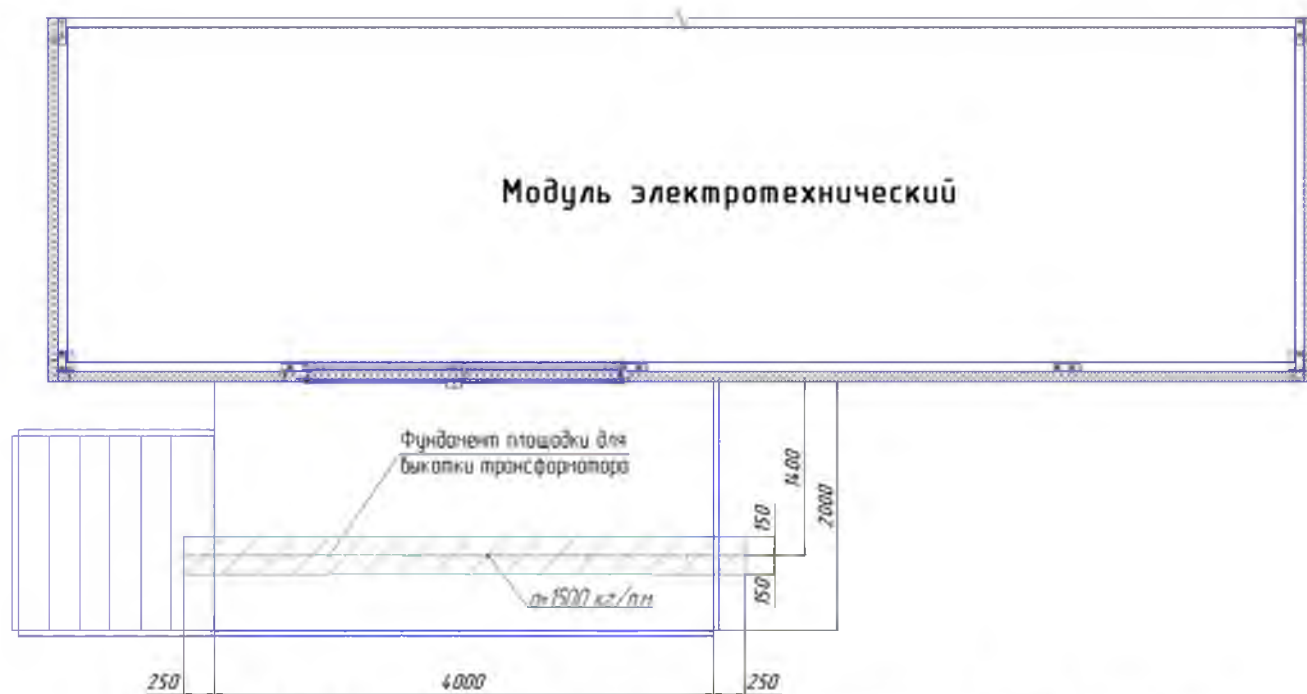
Схема плана ростверка под площадку 4000x2000 мм
